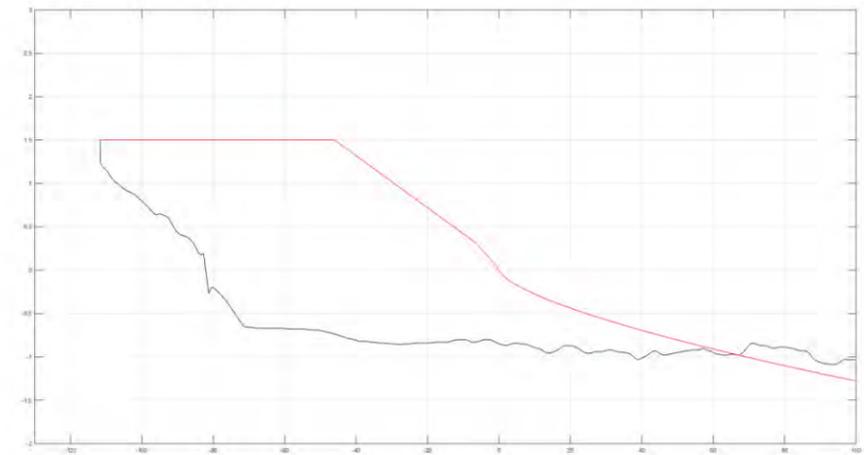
Detalle del Perfil 2, para el cálculo del volumen de aportación en la alternativa 4. Fuente: Elaboración propia.
